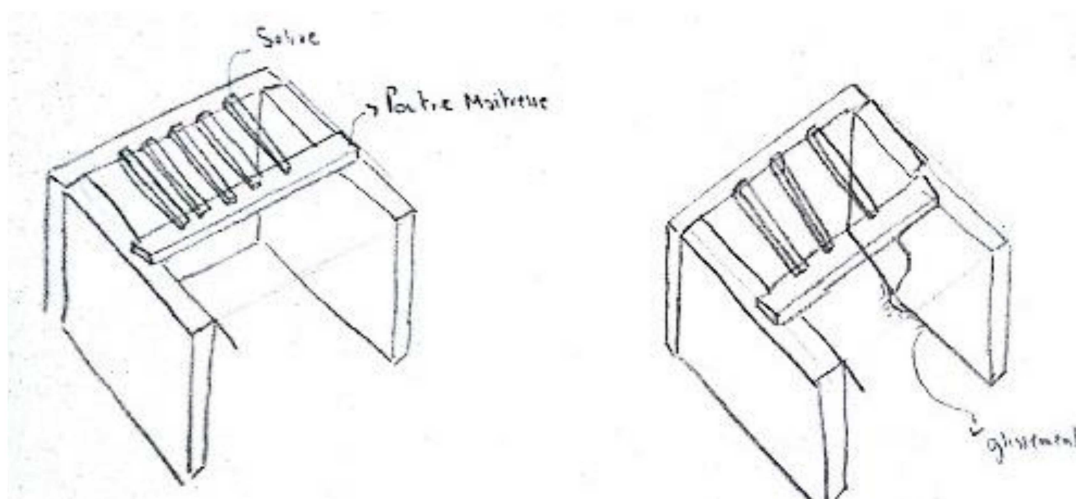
Inclinaison de plancher vers la poutre maitresse.
